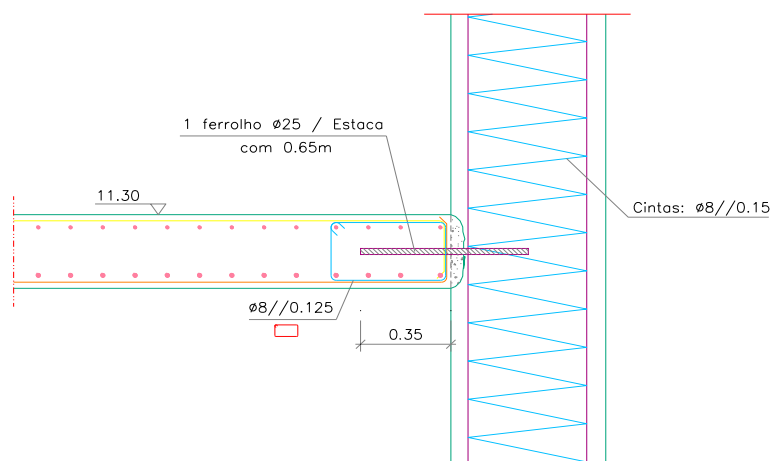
Pormenor de ligação das lajes à cortina de estacas no piso -1.
